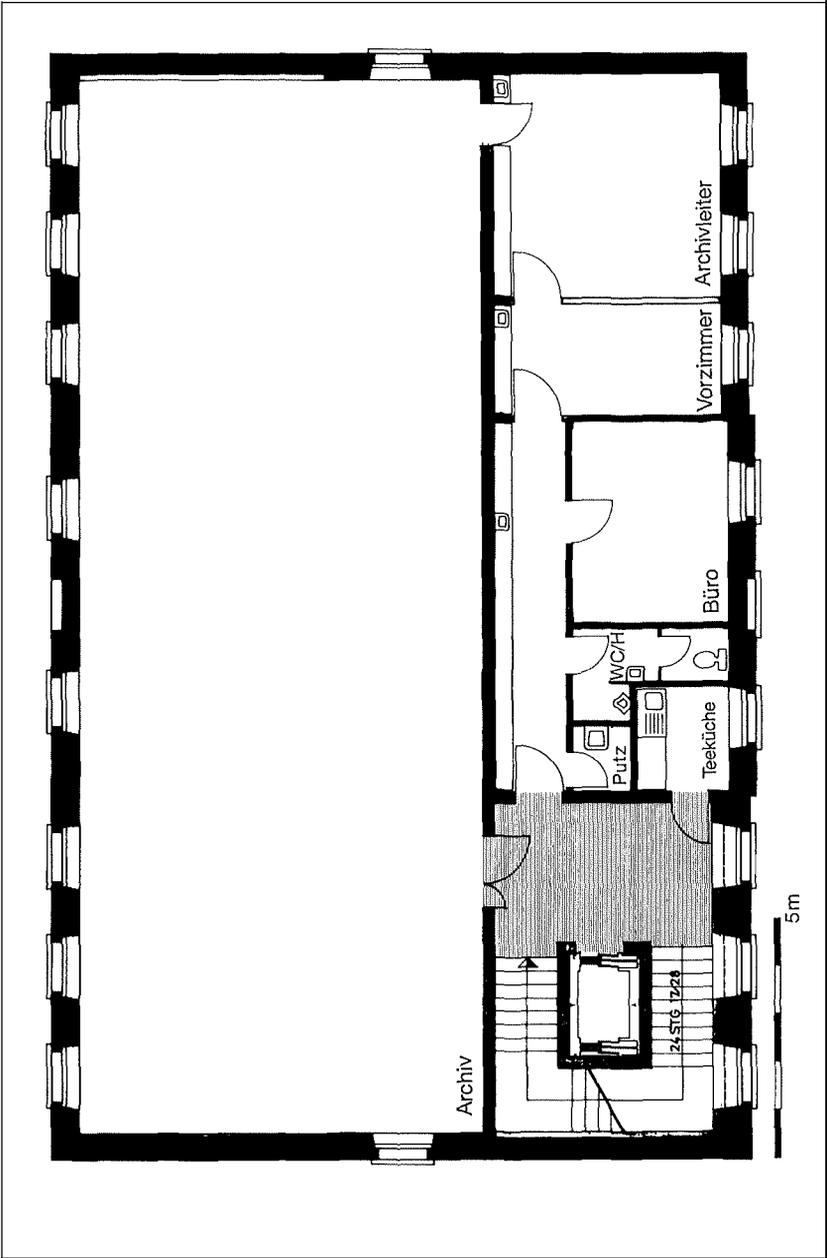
Stadtarchiv Wuppertal, Archivgebäude. Erdgeschoß-Grundriß.
